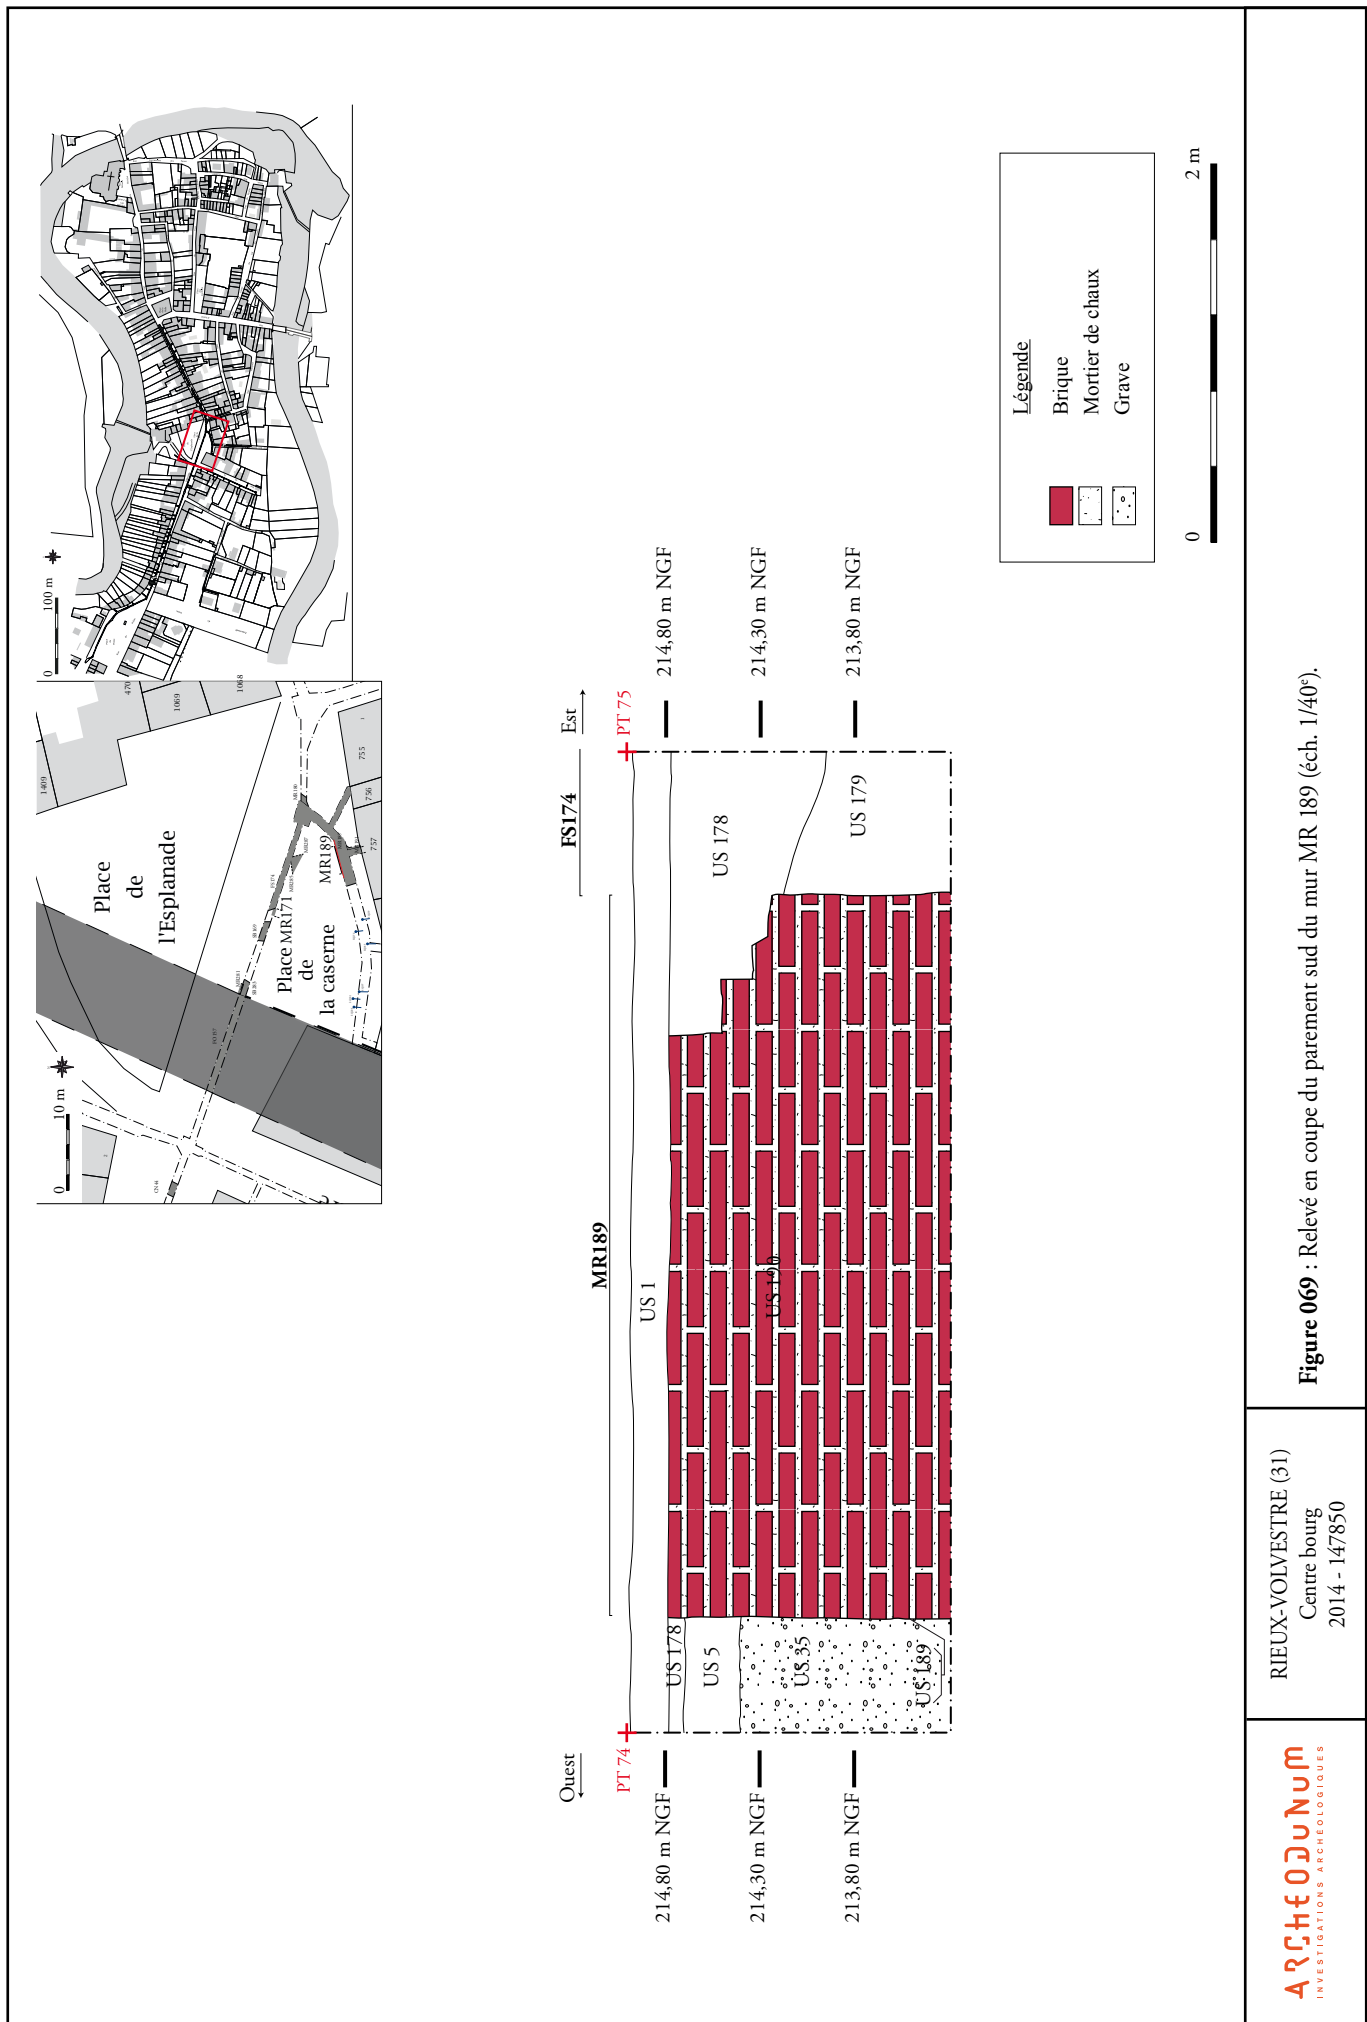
Relevé en coupe du parement sud du mur MR 189 (éch. 1/40^e).
